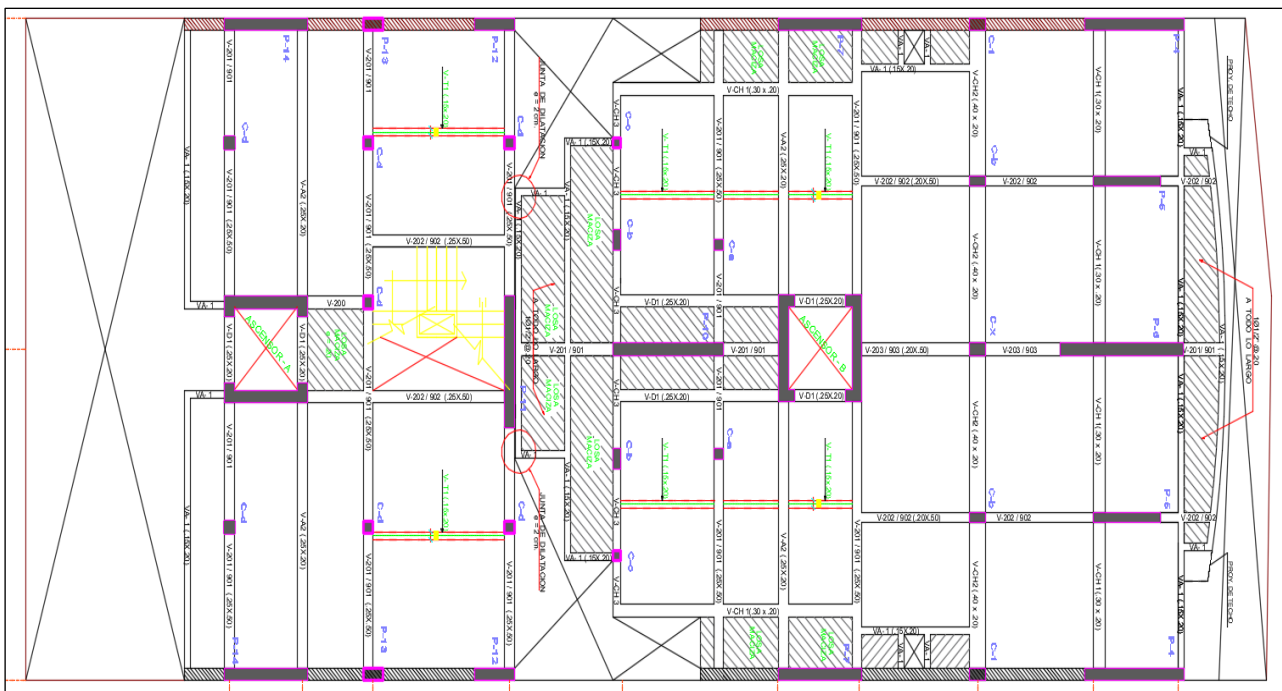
Distribución en planta de los elementos estructurales (1er Piso)
